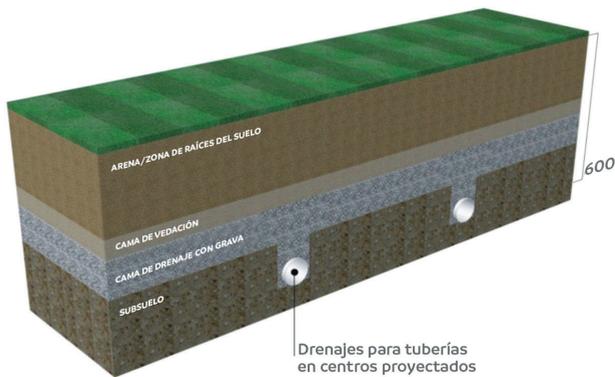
Perfil de una cancha con tuberías de drenaje en suelo natural
